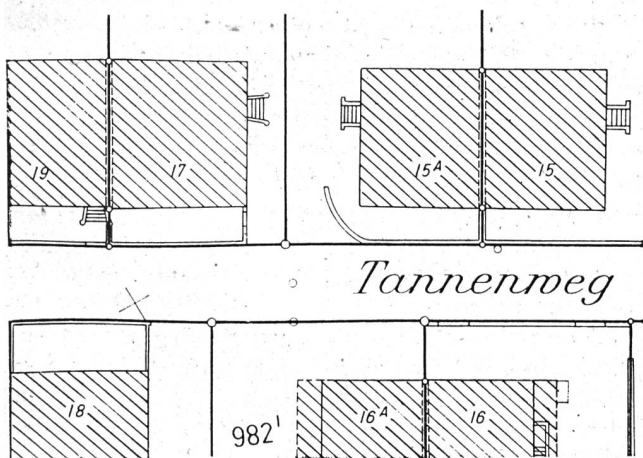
Grundbuchplan 1:500; Vermessungsamt der Stadt Bern.
